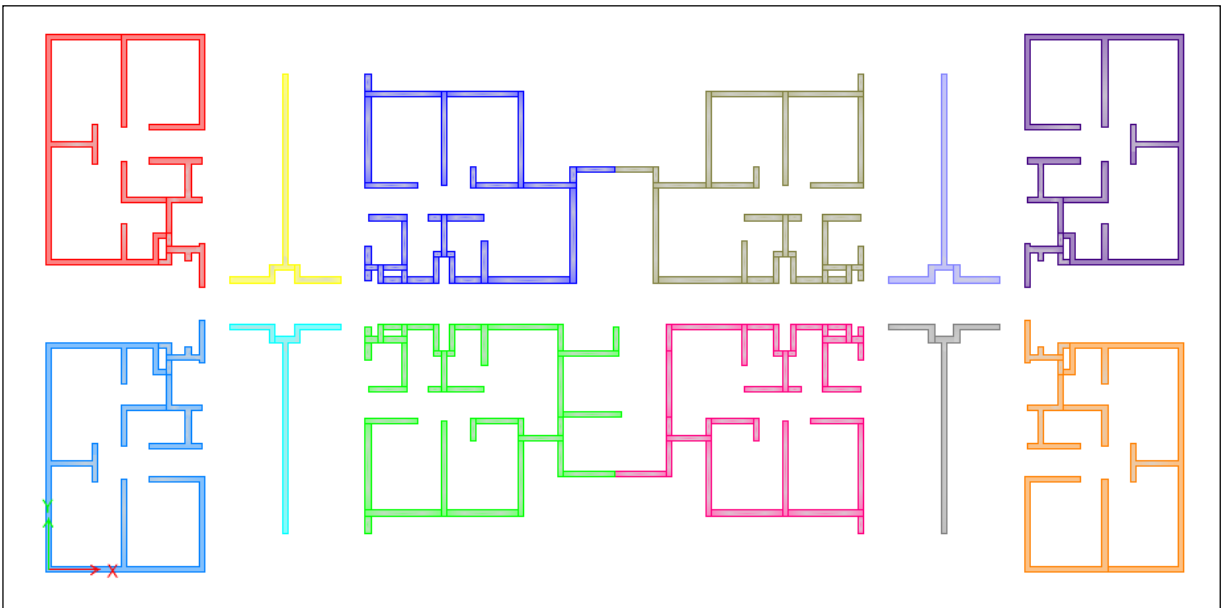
Vista en planta del Edificio H (elementos tipo barra de sección transversal irregular)
